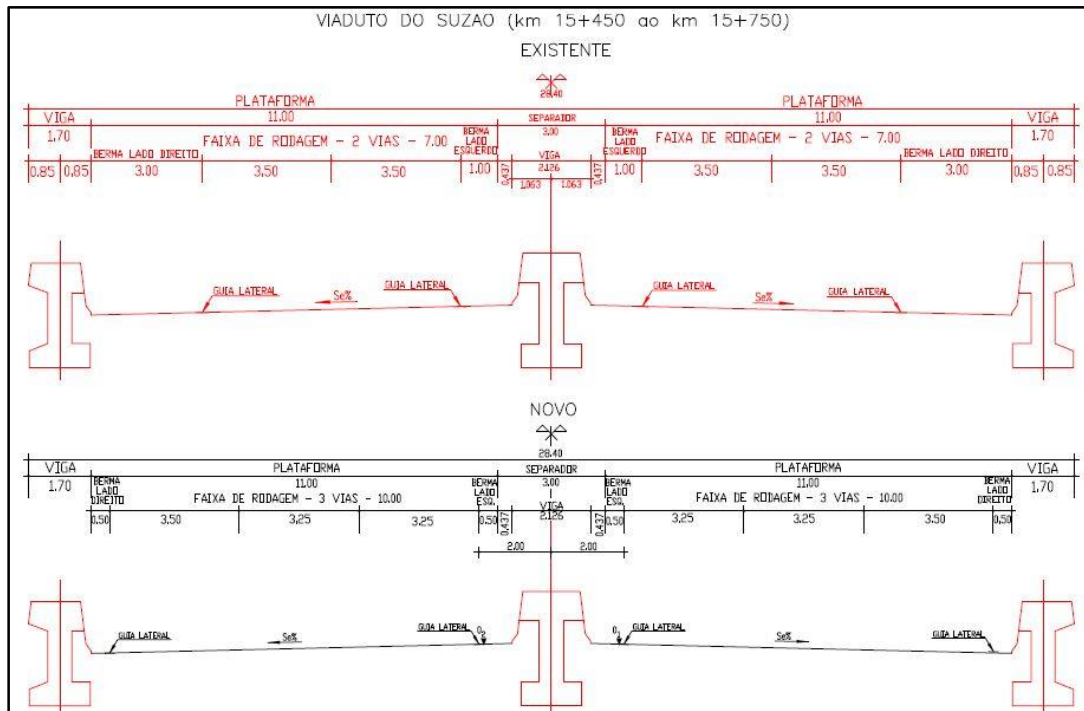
Viaduto do Suzão. Perfil Transversal Tipo [19]
